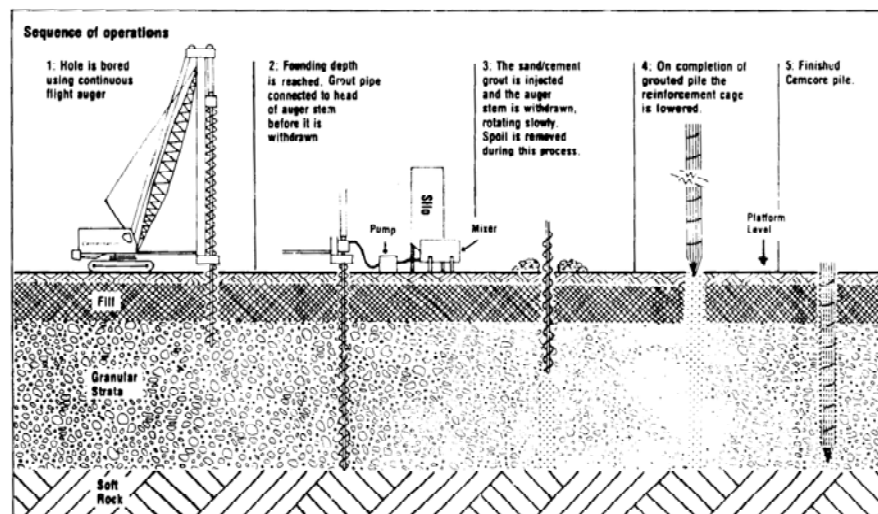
PILOTE BARRENADO SIN SOSTENIMIENTO. Se caracteriza por: perforación mediante barrena, hormigonado por el interior de la barrena y extracción simultánea de la barrena, se introduce la armadura con el hormigón fresco
